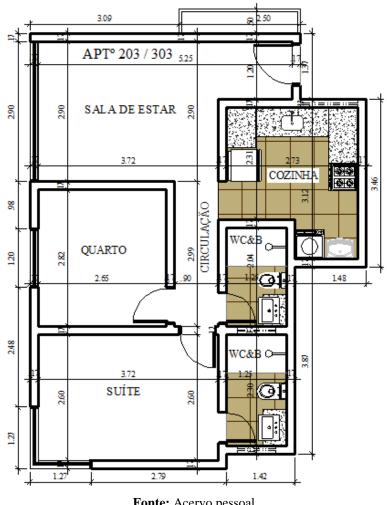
Planta Baixa de UHC de Tipologia 2 (Pavimento tipo)
